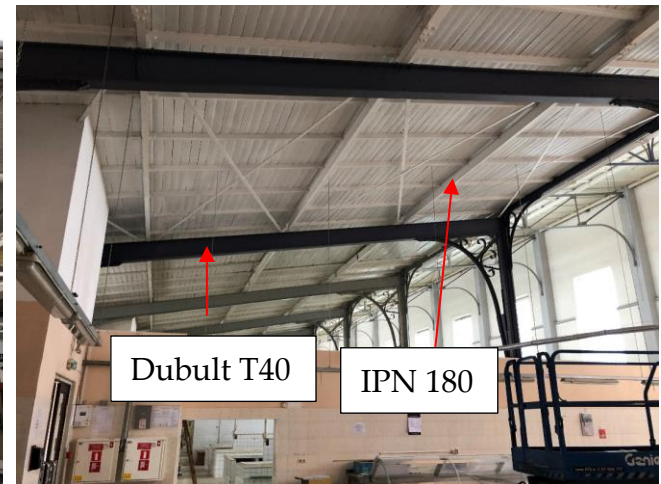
Zemās jumta daļas konstrukcija.
